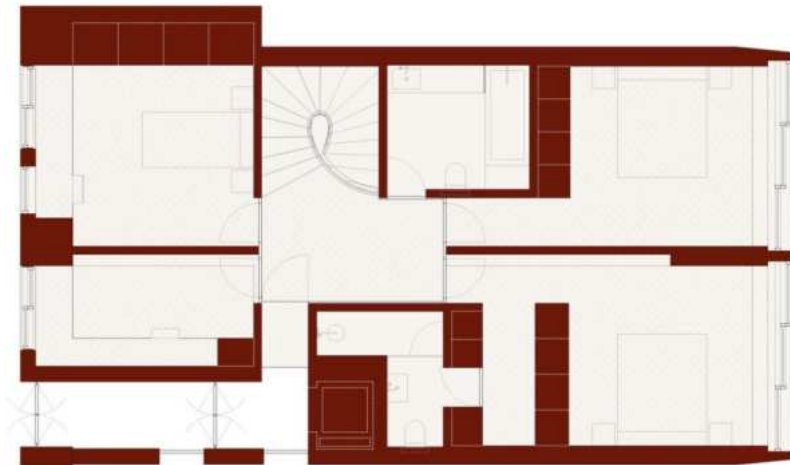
Planta do segundo piso (ArchDaily, 2008b)
